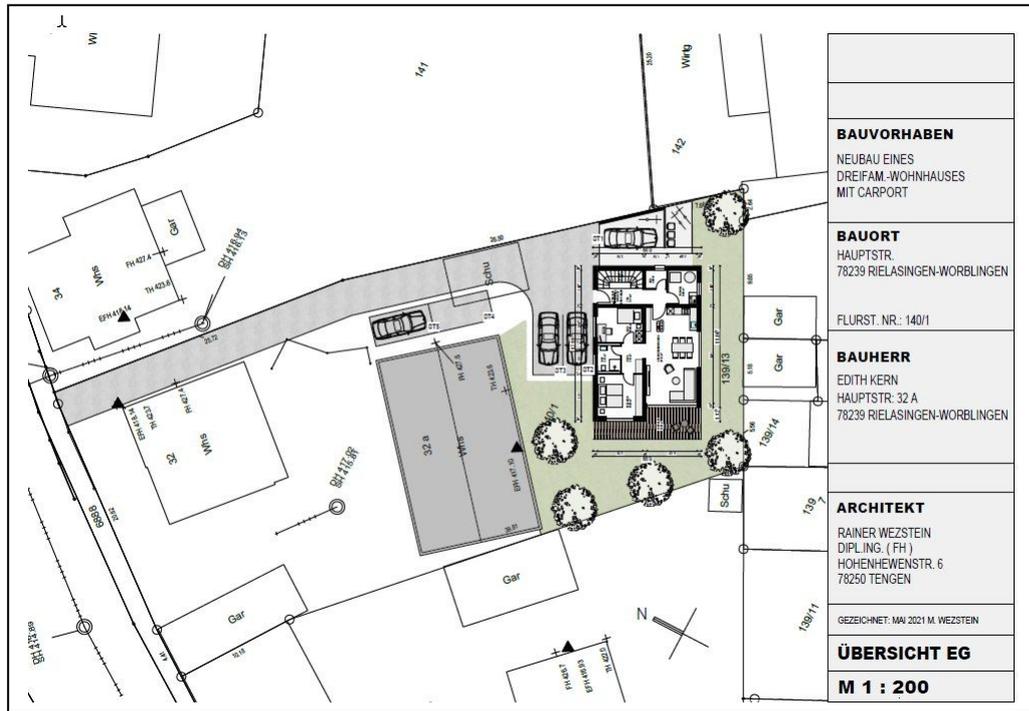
Lageplan zum Bebauungsplan „VBP Nördliche Hauptstraße 6. Änderung“ in Rielasingen (ARCHITEKT R. WEZSTEIN in lit. 2021)
